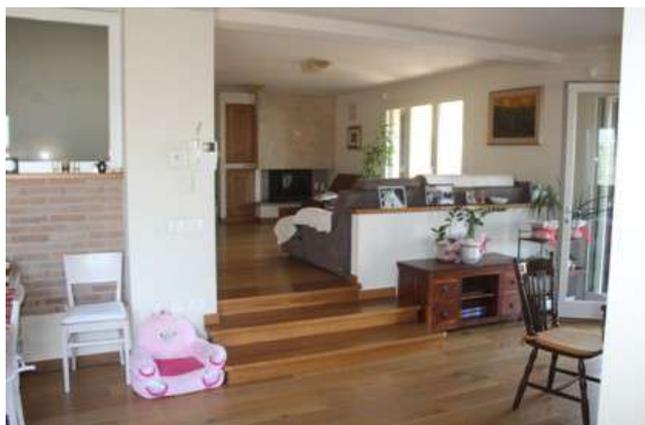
33: soggiorno - zona ad altezza 230 – accatastata come dispensa
